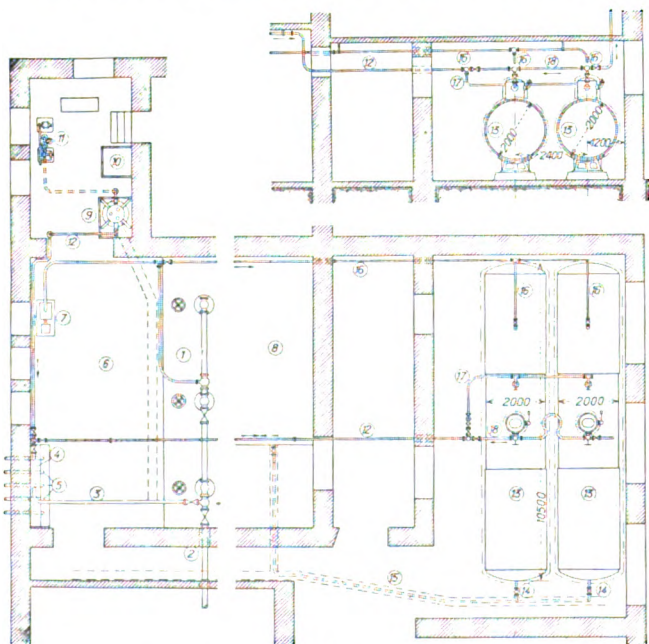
Grundriss des Kesselhauses. — 1 : 250.
